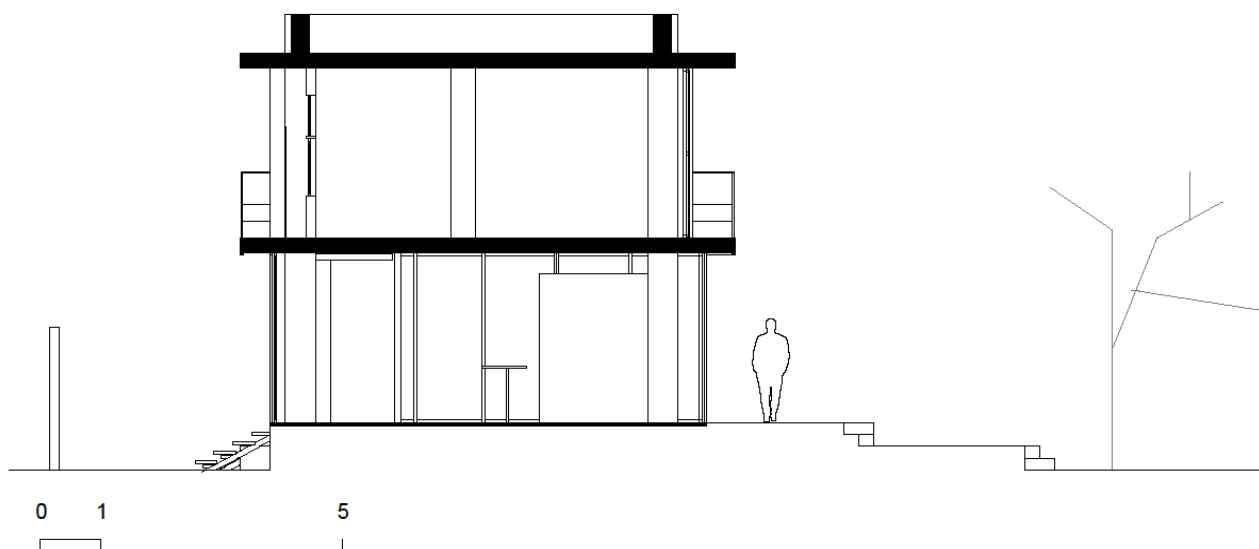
Corte transversal. Fonte: AUTOR (2017).
